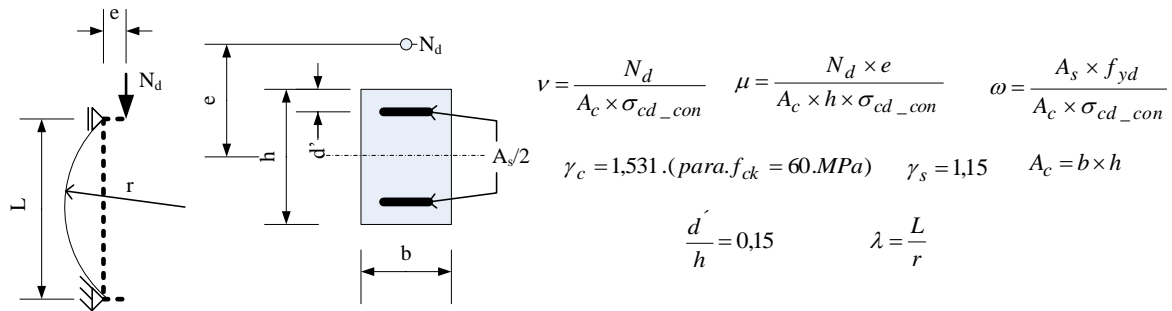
Esquema de la sección transversal y parámetros de dimensionamiento.
